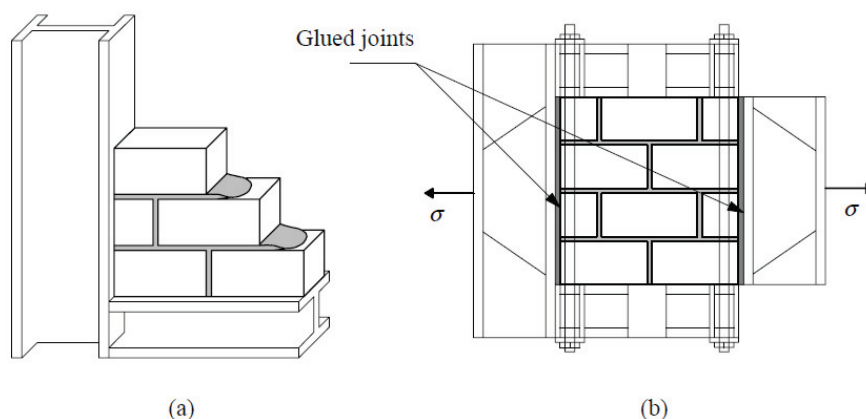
Essai de traction dans la direction parallèle aux joints horizontaux :
